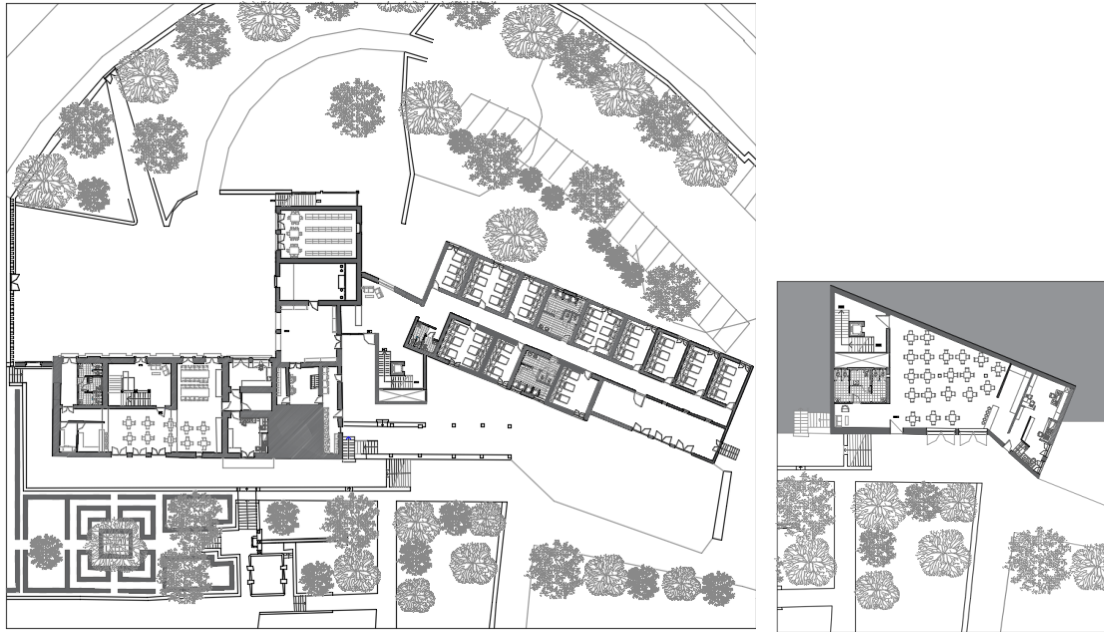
Planta Esquemática do piso térreo e das áreas de serviço da pousada do Piso -1
